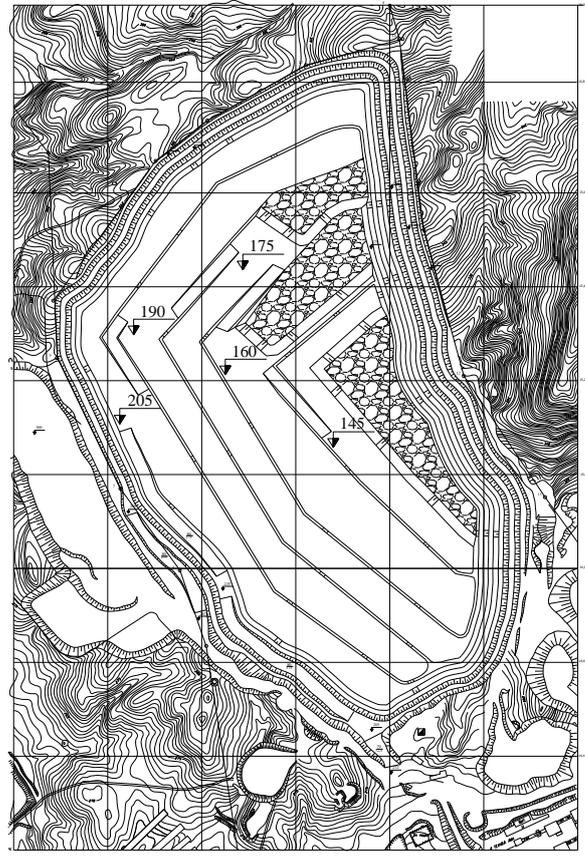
Промежуточный план горных работ продольно-поперечным фронтом работ (4 этап)
